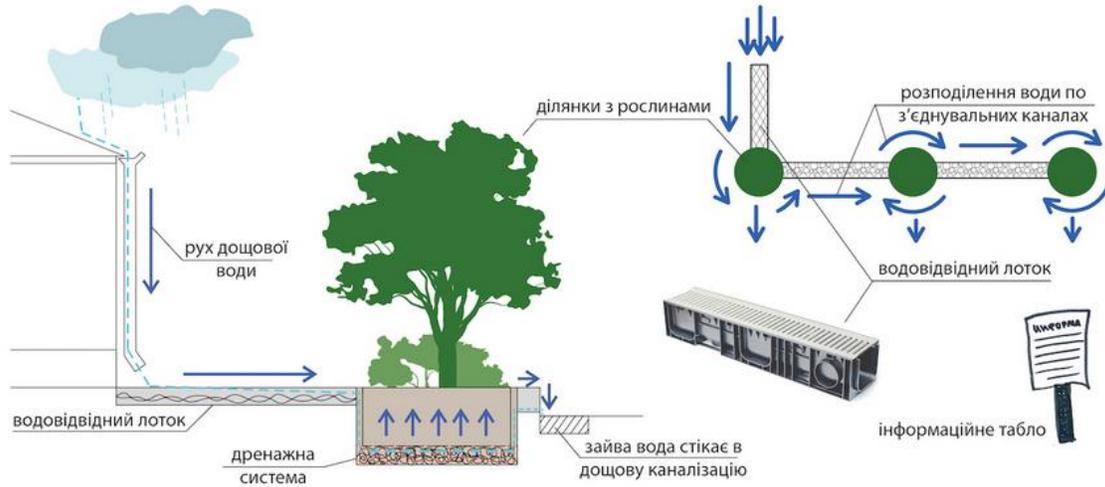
Схема дощового саду на Подолі (м. Київ)
